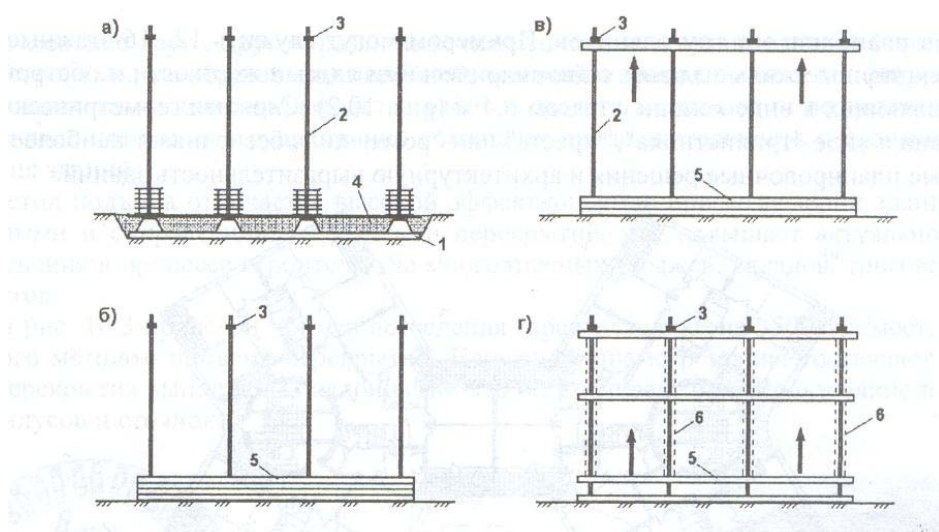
Принципиальные технологические схемы возведения зданий методом подъема перекрытий (а...г) 1 – фундаментная плита; 2 – направляющие (колонны); 3 – домкраты; 4 – засыпка основания; 5 – пакет монолитных плит перекрытия; 6 – грузовые тяги; 7 – монтажный кран; 8 – панель стены.
